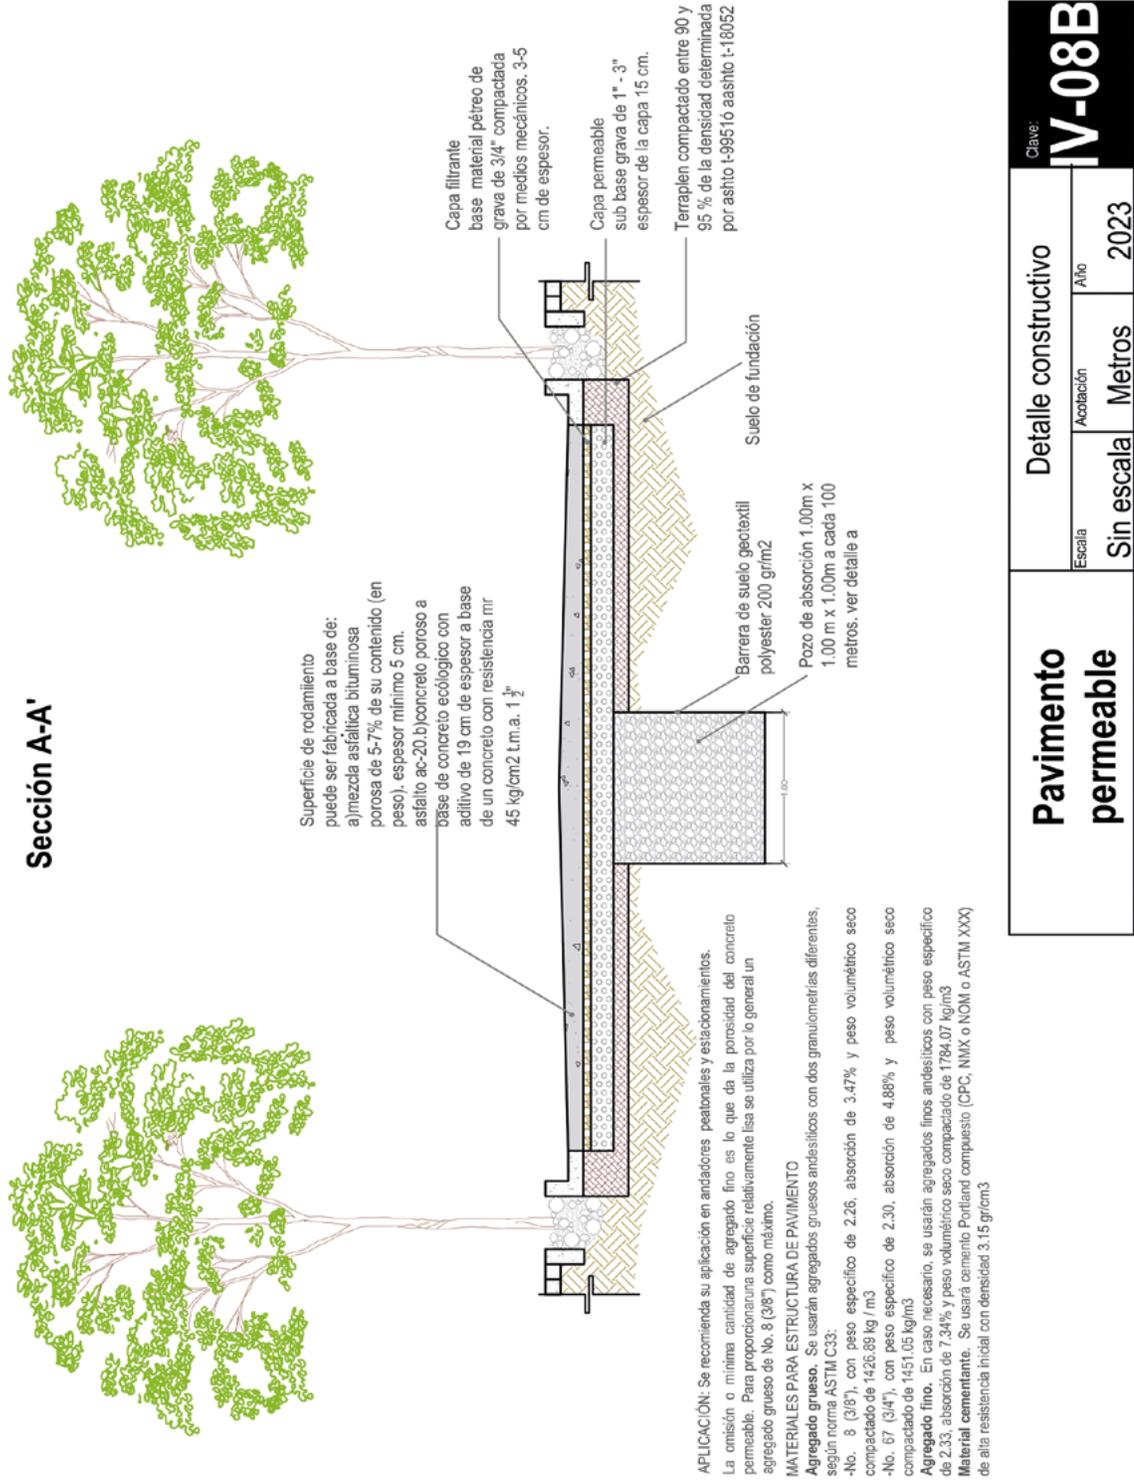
Detalle Constructivo de Pavimentos Permeables.
